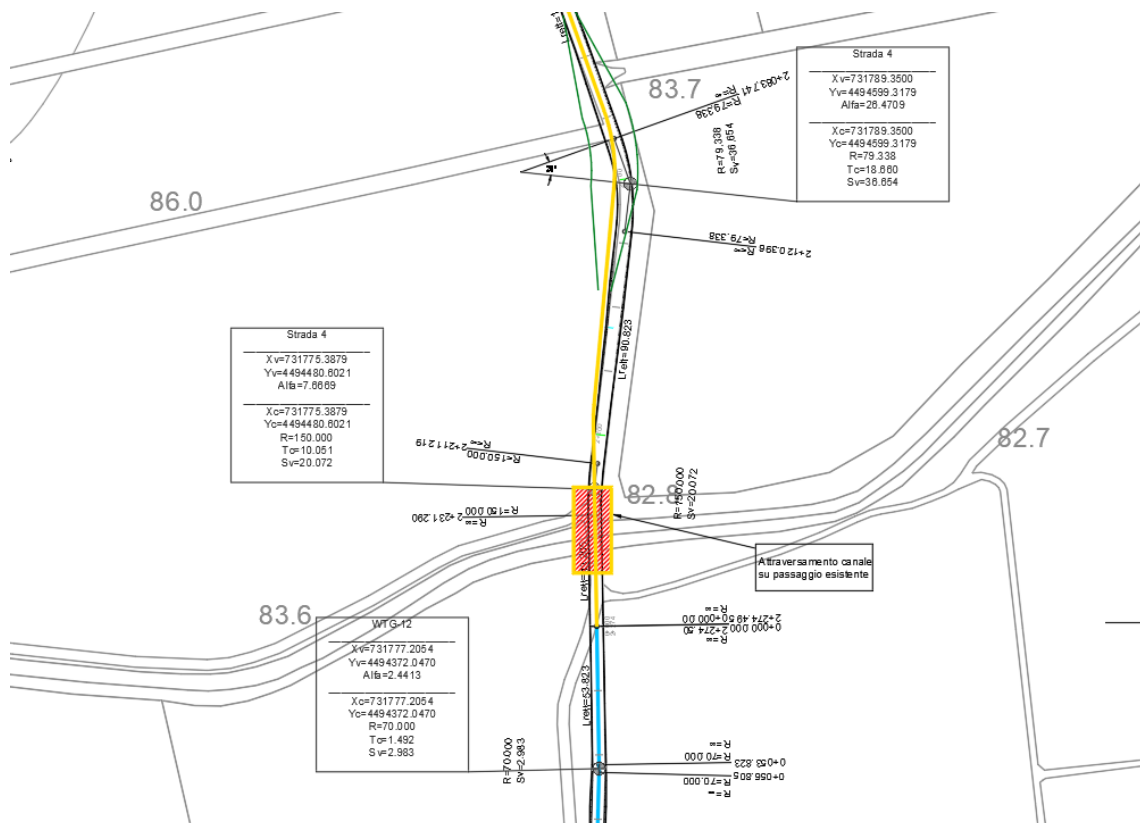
Individuazione dell'attraversamento del canale su planimetria
